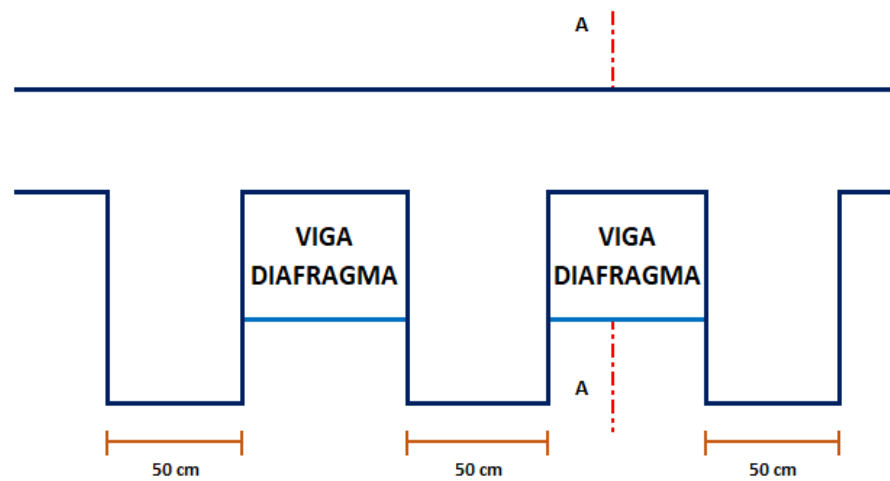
CORTE TRANSVERSAL PUENTE-FUENTE: ELABORACION PROPIA
